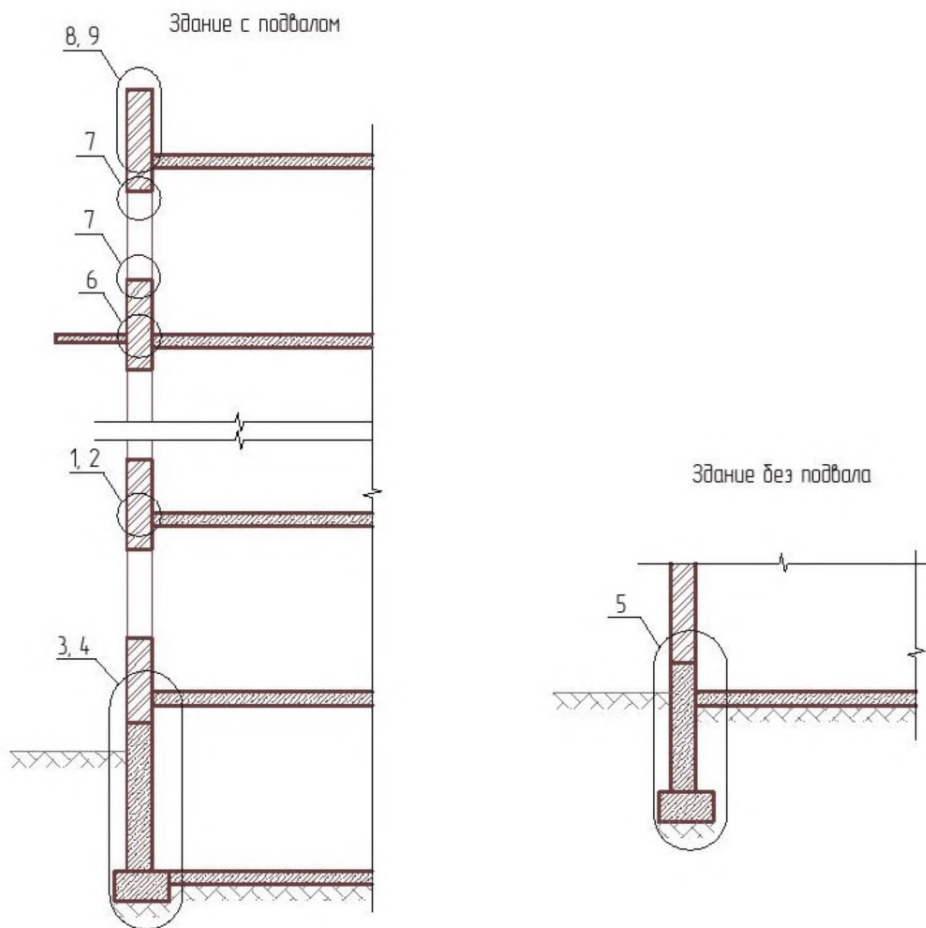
Схема нумерации узлов на поперечном разрезе здания
